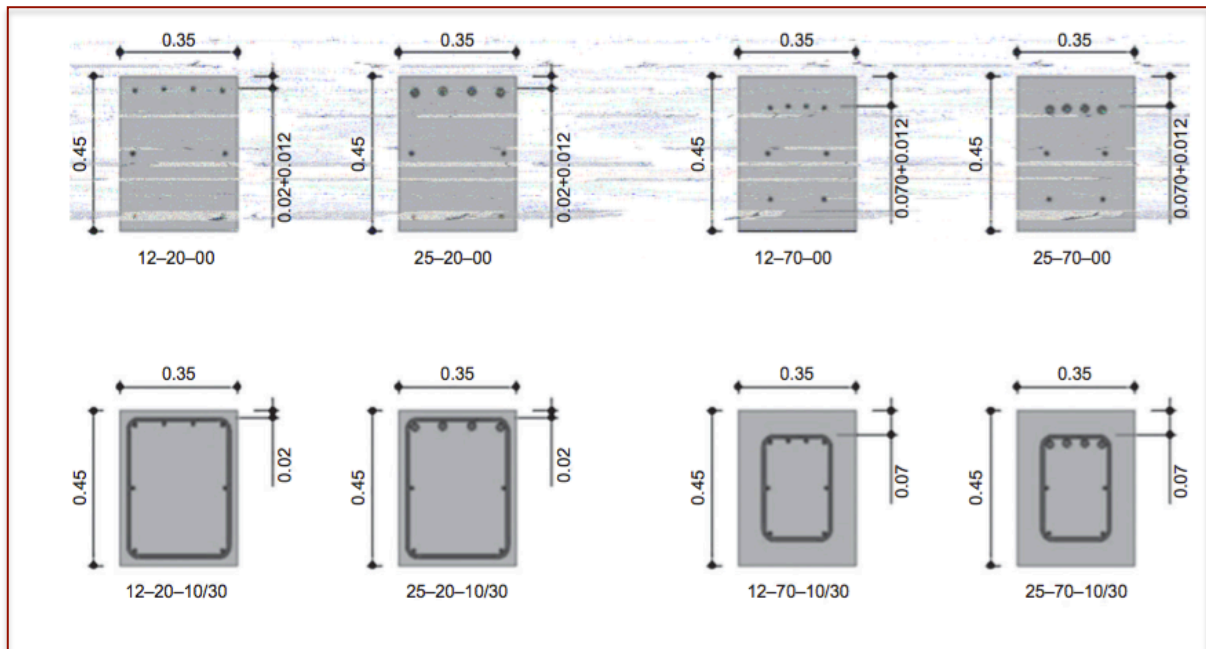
Secções transversais das vigas de betão armado a ensaiar [7].
